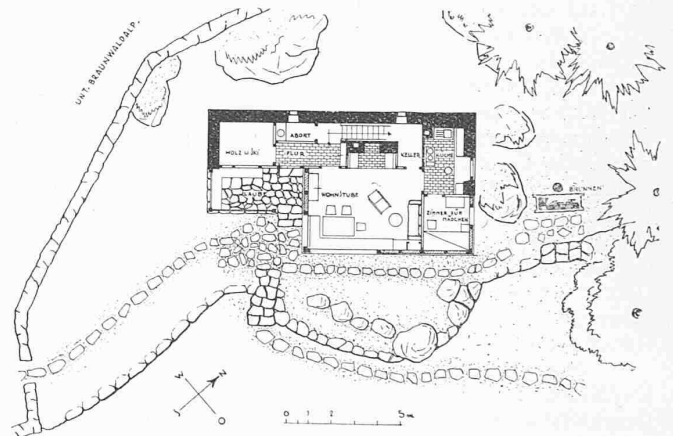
Lageplan mit Erdgeschoss-Grundriss. — Masstab 1:300.
